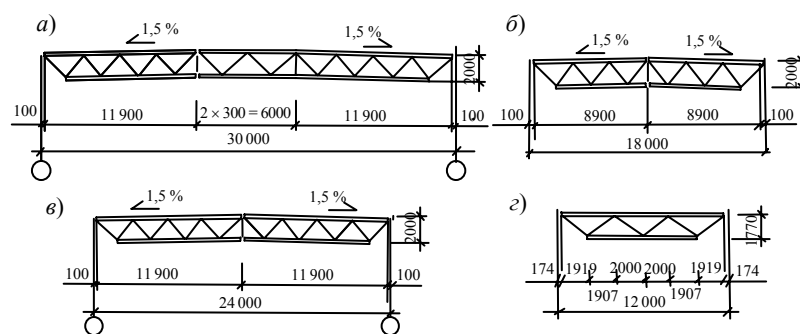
Схемы ферм покрытия типа «Молодечно»: а, б, в – стропильные фермы; г – подстропильная ферма
